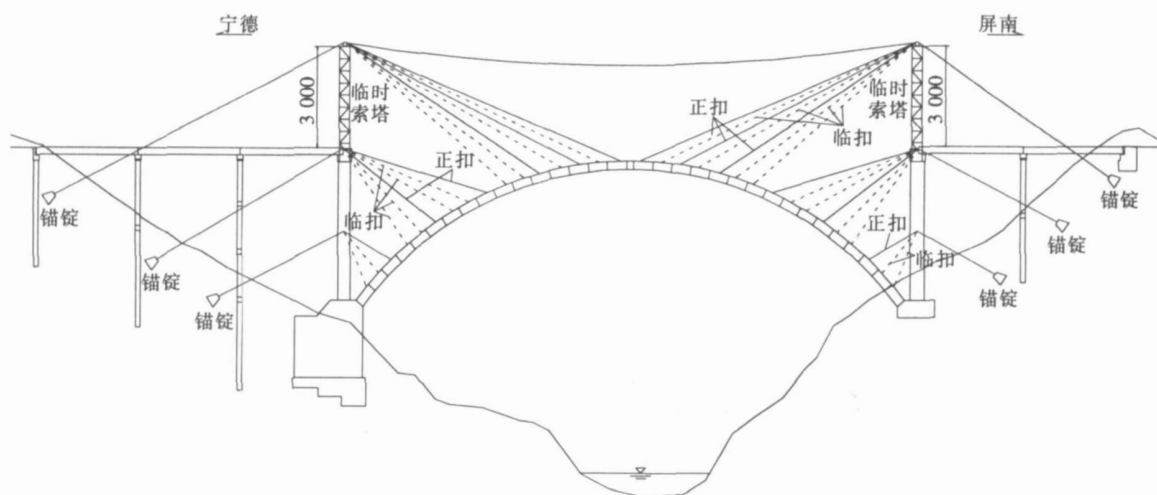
主拱圈悬臂浇筑施工示意图(单位:cm)
